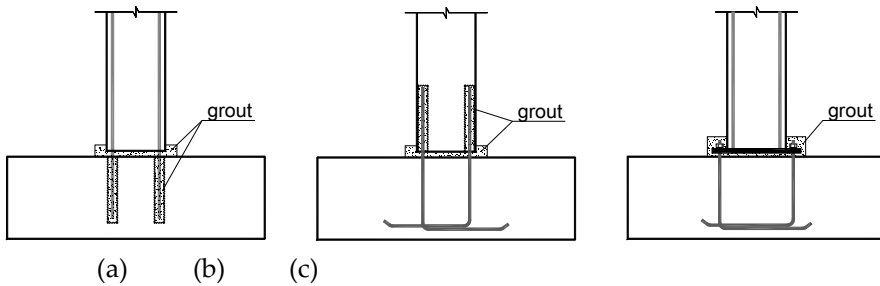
Ligações pilar-fundação (a) com armaduras salientes do pilar embebidas na sapata, (b) com armaduras salientes da sapata embebidas no pilar, e (c) com armaduras salientes da sapata aparafusadas em chapa metálica existente no pilar (Lúcio, 2000).
